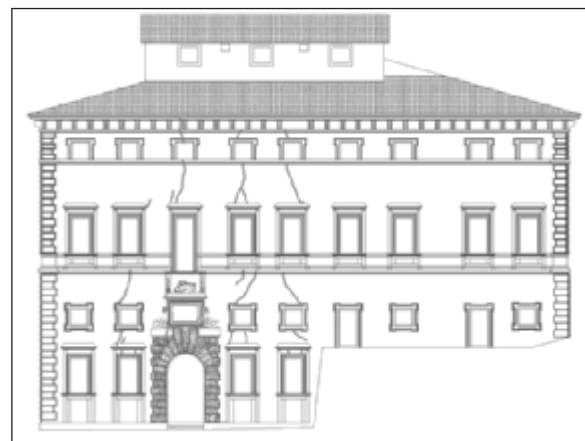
Quadro fessurativo attuale sul prospetto Est.
